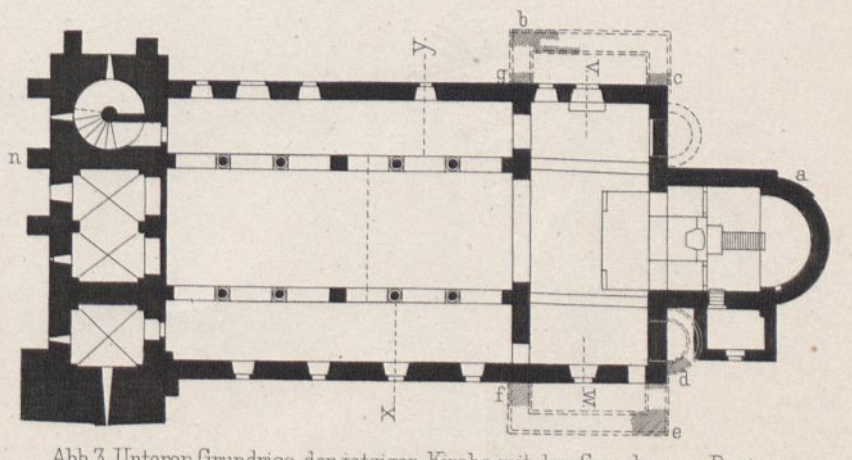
Unterer Grundriss der jetzigen Kirche mit den Grundmauer-Resten
